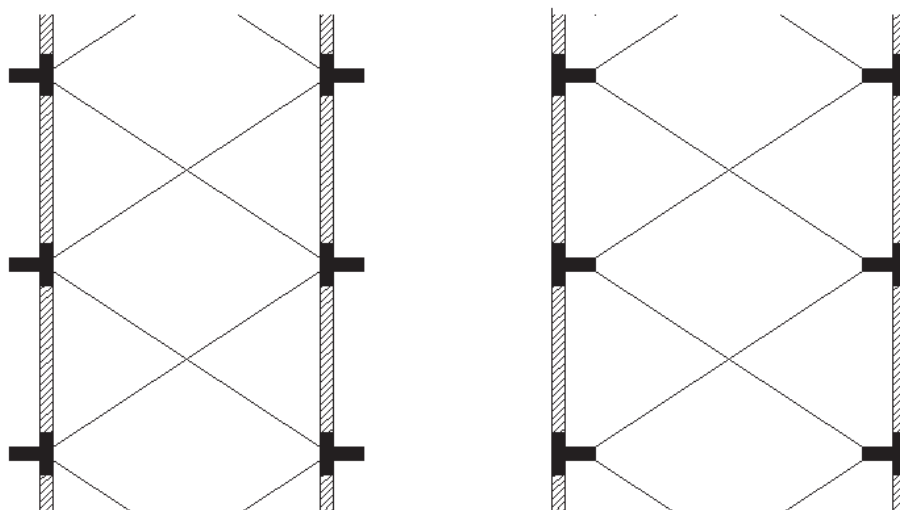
Planta de una nave abovedada con contrafuertes exteriores y planta abovedada con contrafuertes interiores. (Dibujo del autor).
